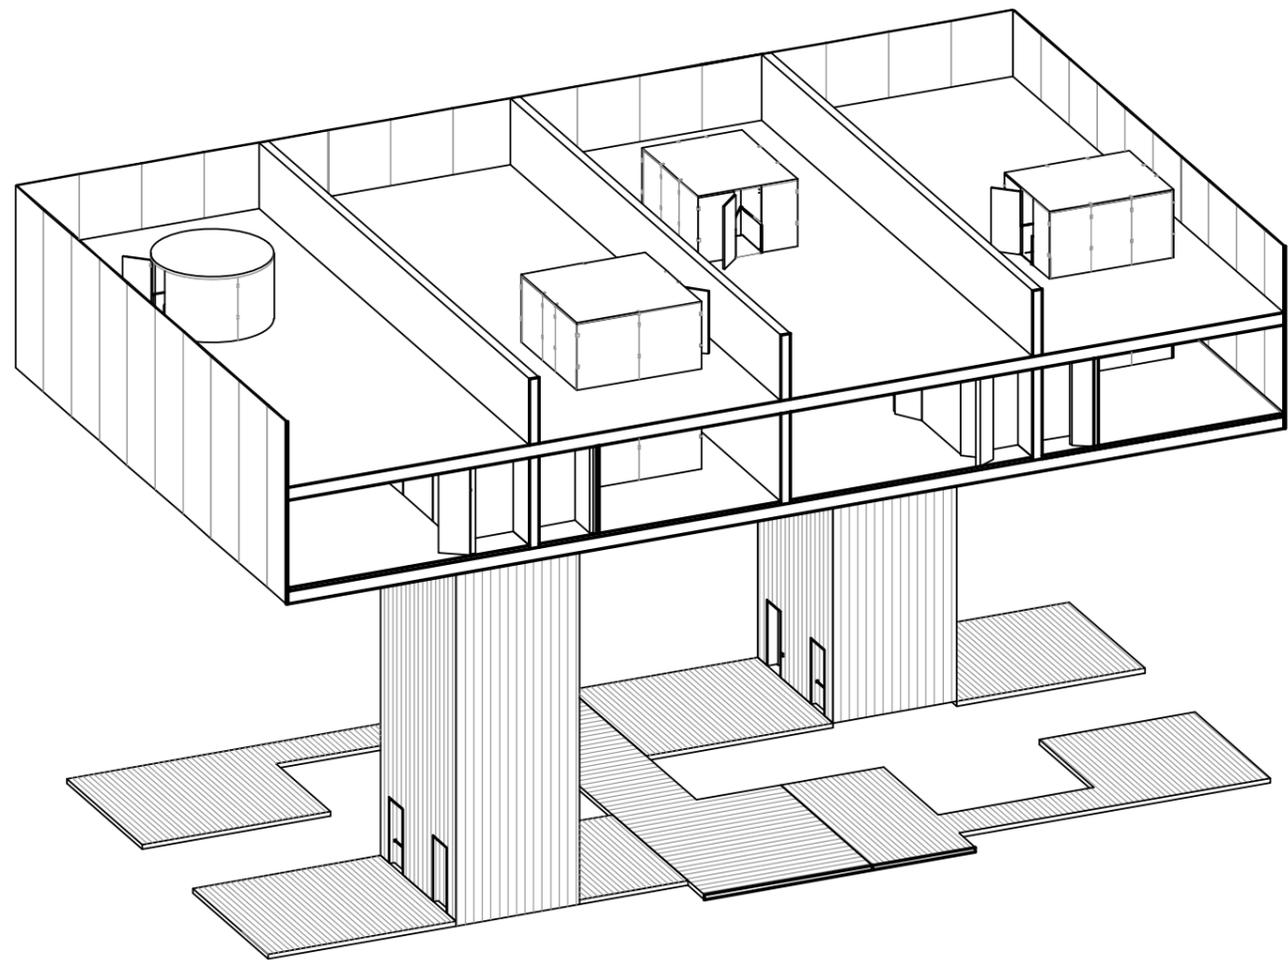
Axonometría con corte vertical sobre las viviendas
